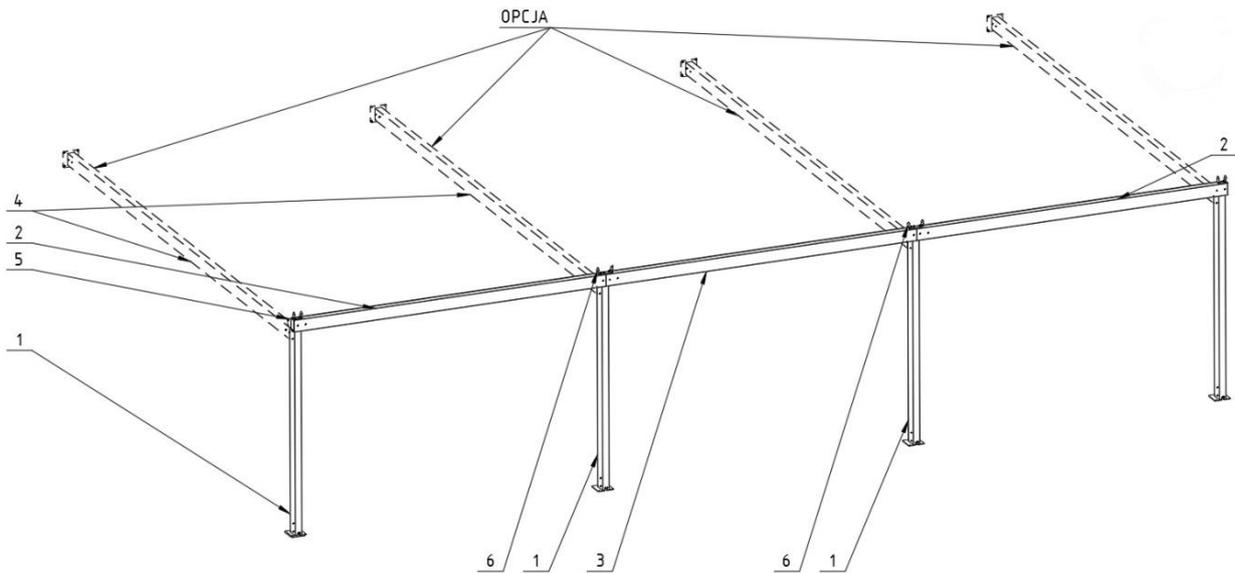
Structure de support Version murale modulaire : 1 - Poteau bas 2 - Poutre frontale (droite, gauche), 3 Poutre frontale (intermédiaire) 4 - Poutre latérale, 5 - Gouttière, 6 Support de poutre de guidage modulaire.
